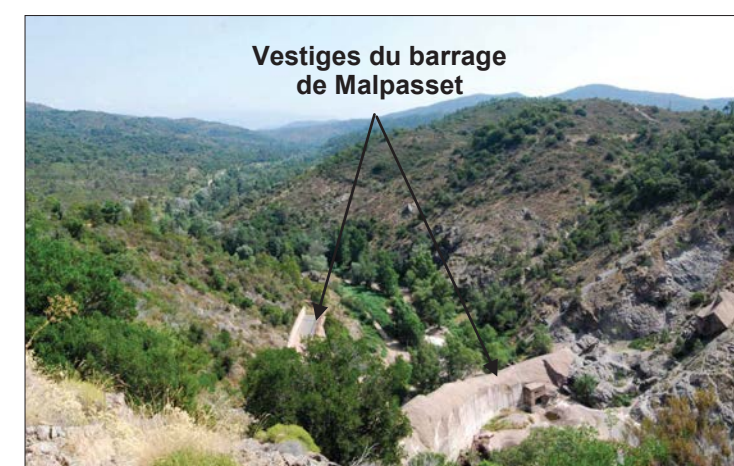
Etat actuel du barrage de Malpasset (2012)
